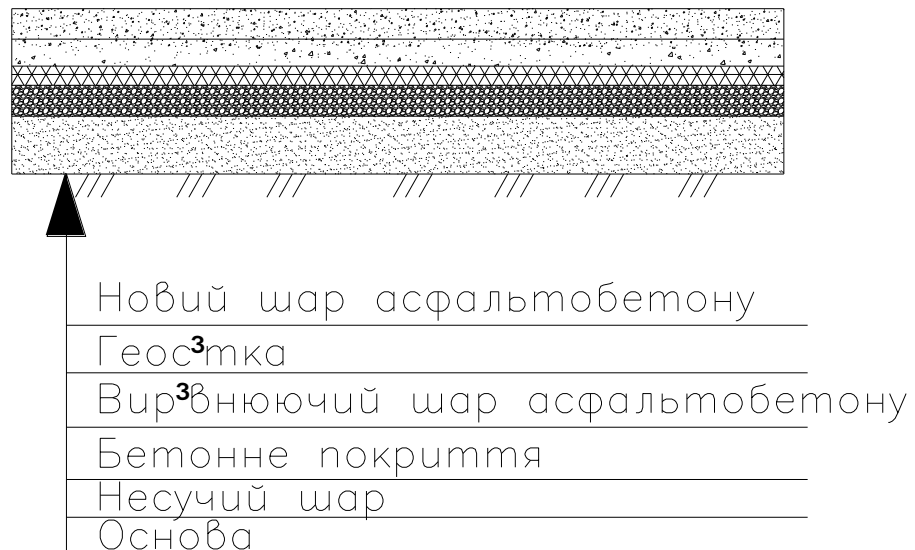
Армування асфальтобетону покладеного на бетонне покриття
